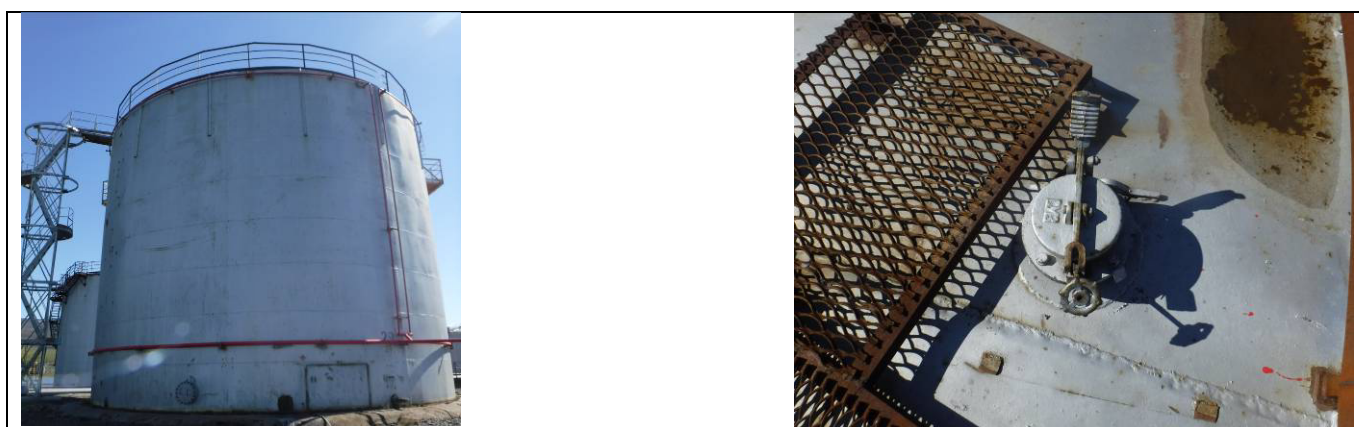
Общий вид резервуара РВС-2000 (№29) с замерным люком
